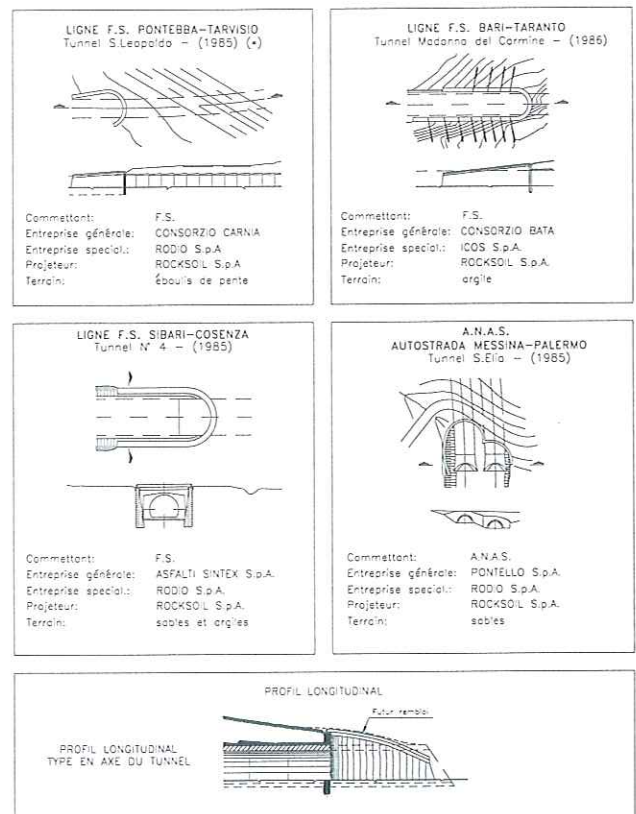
Premières applications d'attaque du tunnel par jet-grouting vertical. First applications of vertical jet-grouting system to create shells of improved ground before tunnel excavation commences.
